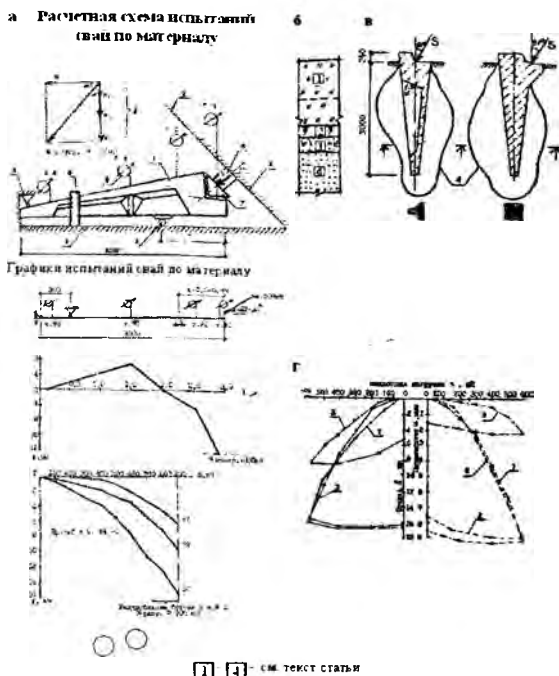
Результаты испытания опытных пирамидальных свай таврового сечения: а – расчетная схема и графики испытания свай по материалу; б – геологическая колонка основания свай на опытной площадке; в – конструкция и схема испытания опытной и контрольной пирамидальных свай таврового и сплошного сечений; г – графики испытаний свай по грунту
